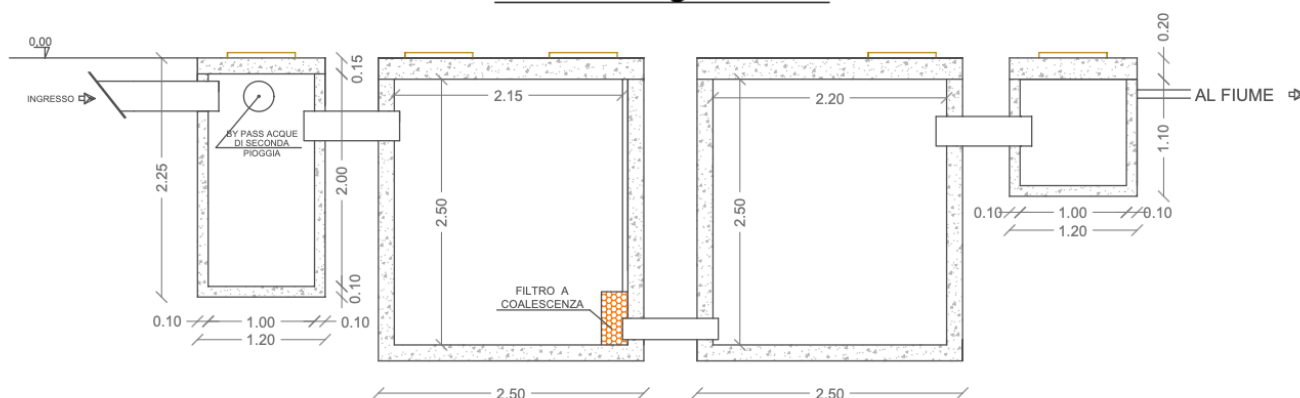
Pianta e sezione sistema di trattamento prima pioggia
